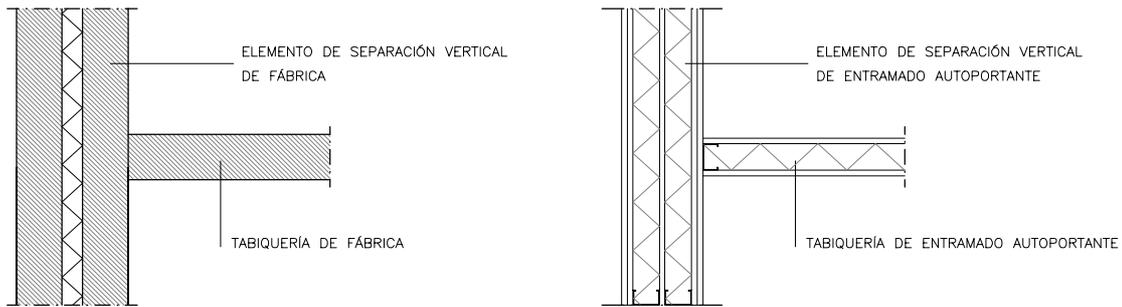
Vista en planta de encuentros de un elemento de separación vertical con un tabique
